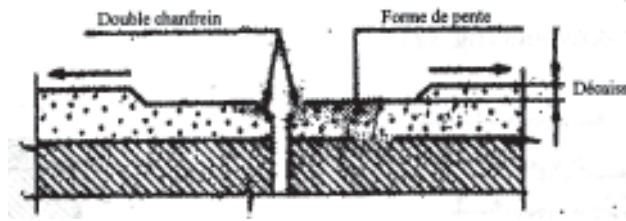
Principe de réservation pour mise en place dispositif joint plat
